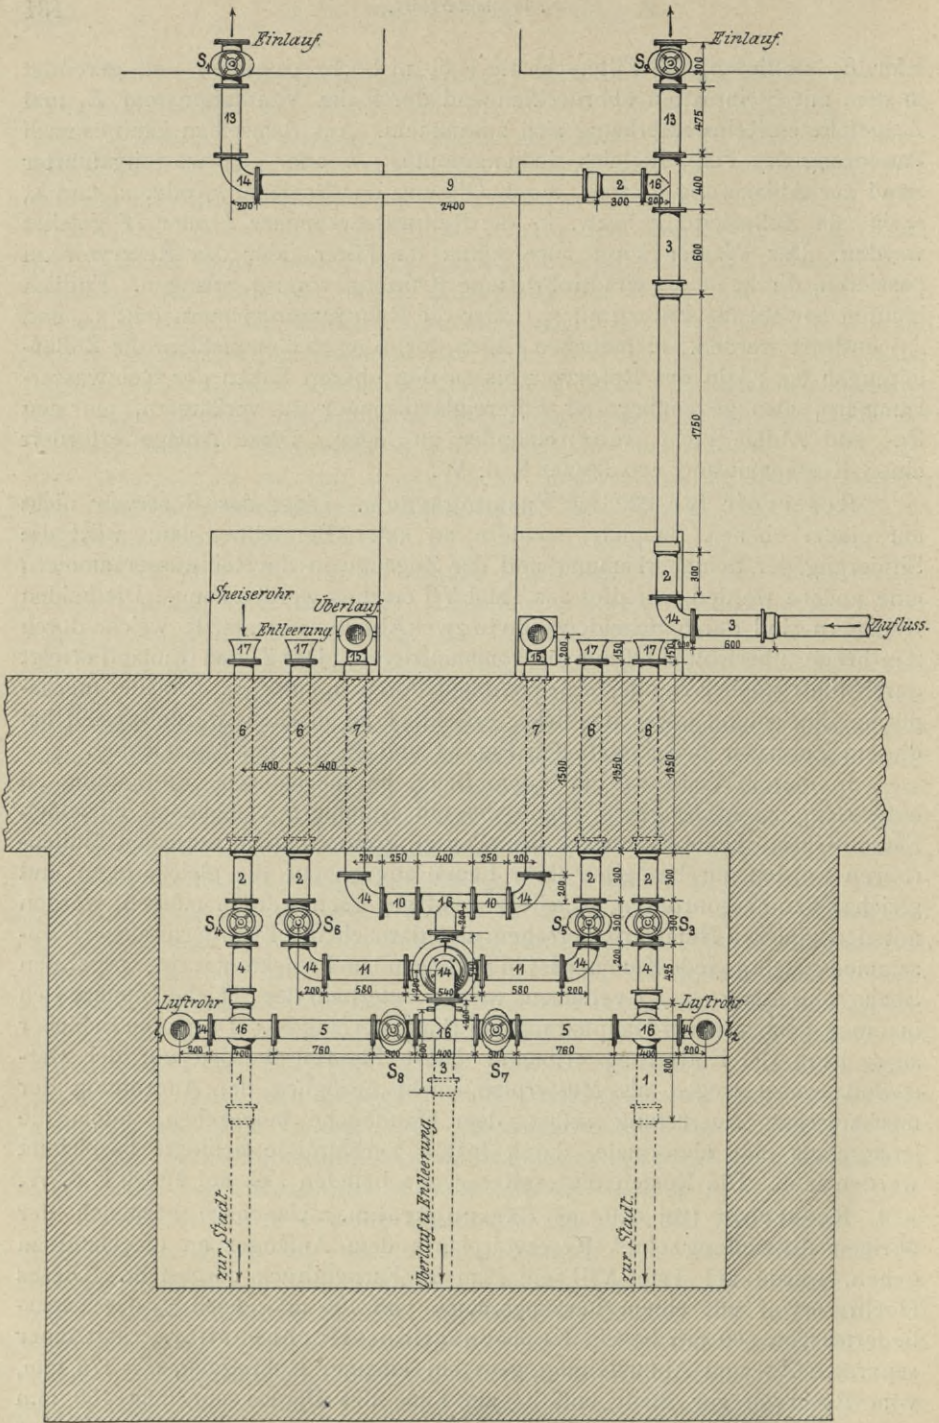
Mechanische Einrichtung eines Hochreservoirs (Taf. VII). Grundriß.
